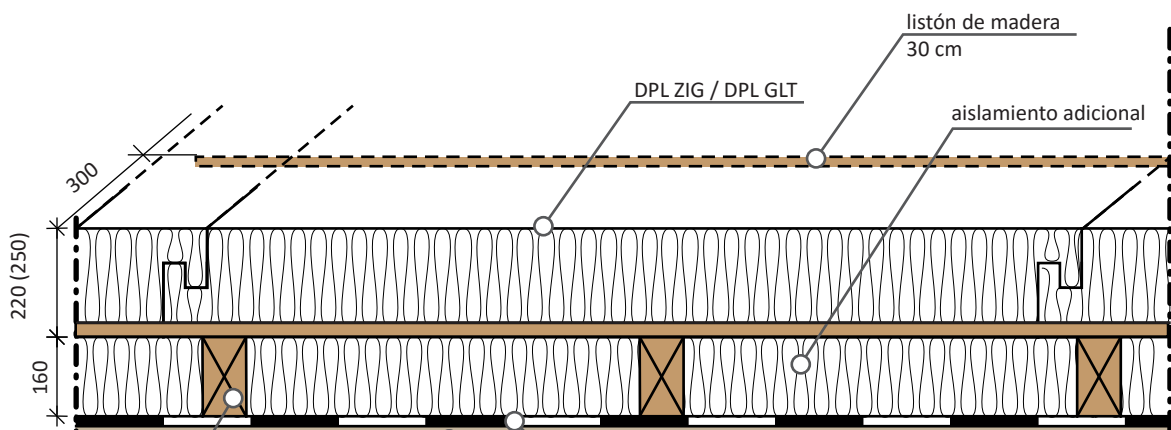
Imagen B. Sección horizontal del vertiente del techo con un aislamiento adicional entre vigas.
